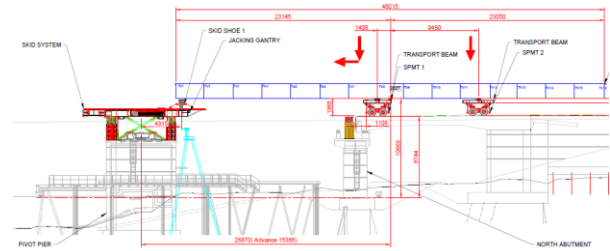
Llegada del voladizo a la estructura temporal sobre la pila-pivote
